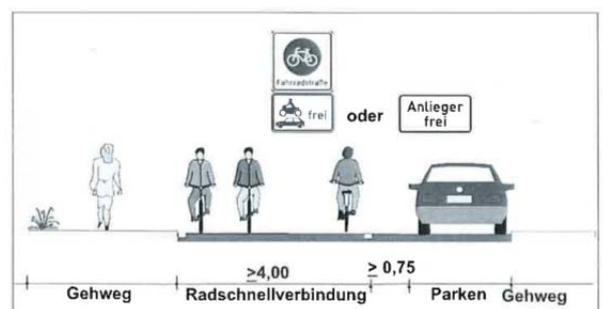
Führung der Radschnellverbindung als Fahrradstraße in Erschließungsstraßen
